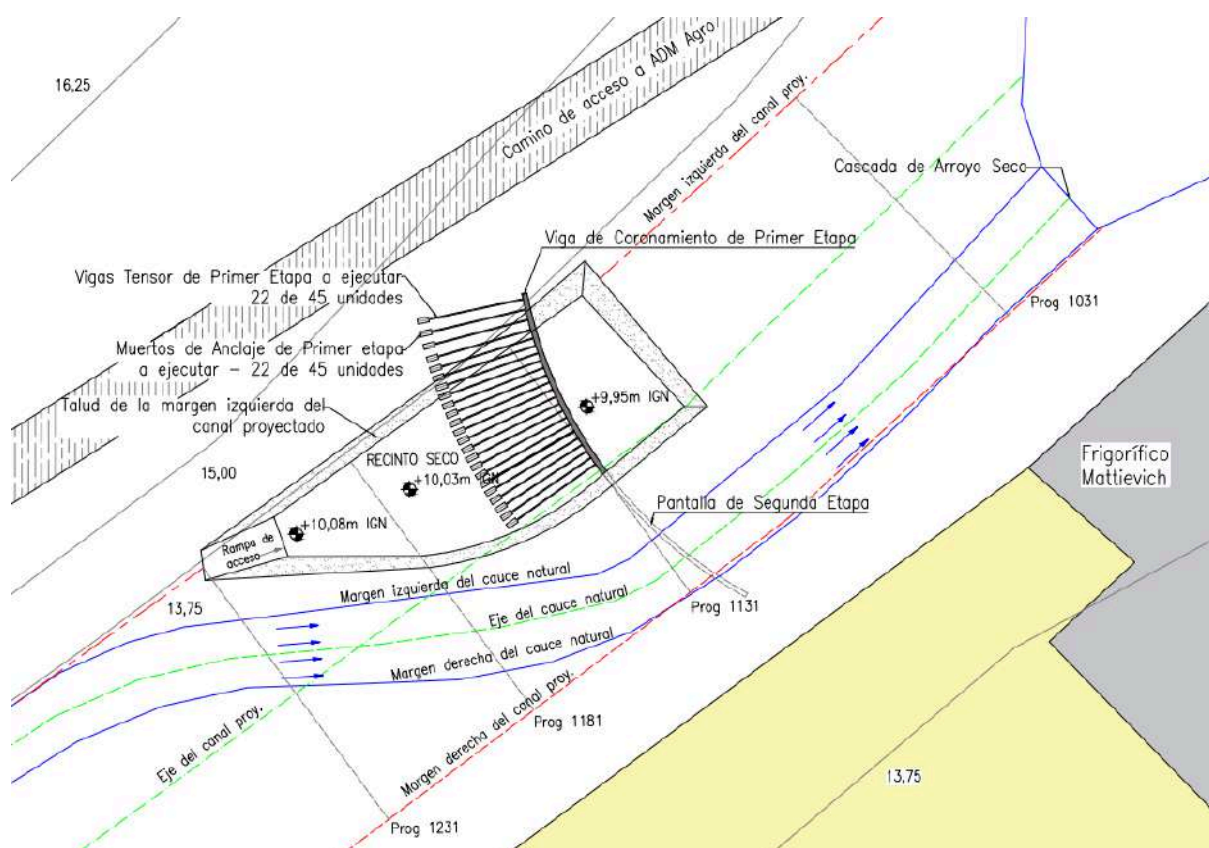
Primera etapa: frente de ataque sobre margen norte. Ejecución de las vigas tensor y muertos de anclaje. Fuente: Elaboración propia.
